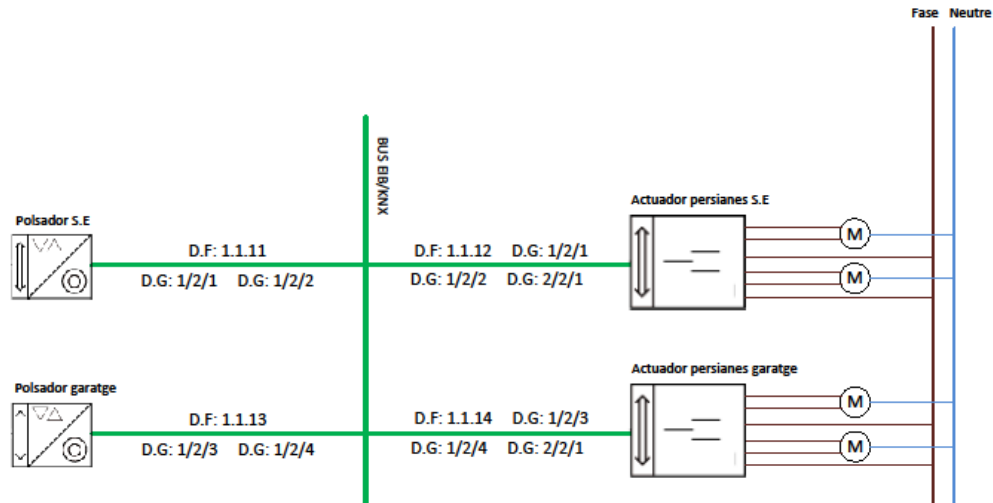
Esquema domòtic de persianes planta subterrània
